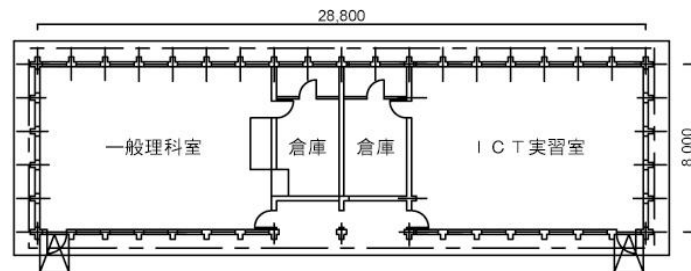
一般理科実験室・ICT 実習室棟 平面図
